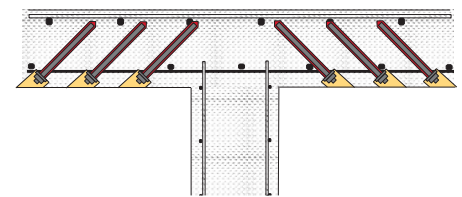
Nachträglich eingebaute Durchstanzbewehrung, die nur von der Unterseite der Platte aufgebracht wird
